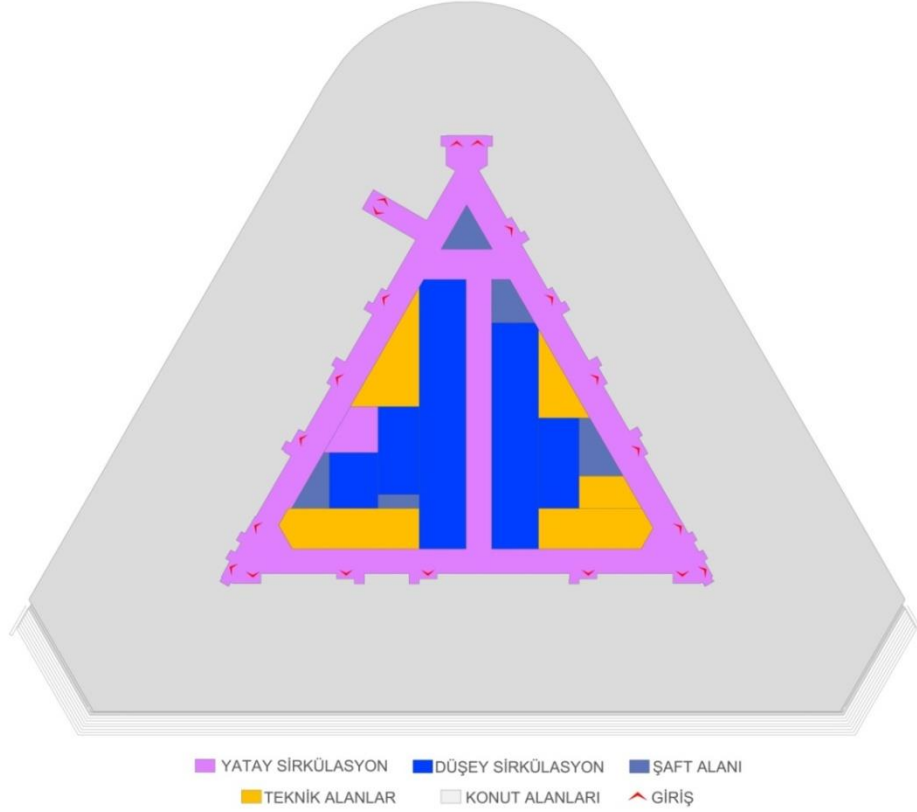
Skyland Konut Plan Tipleri Örnekleri
